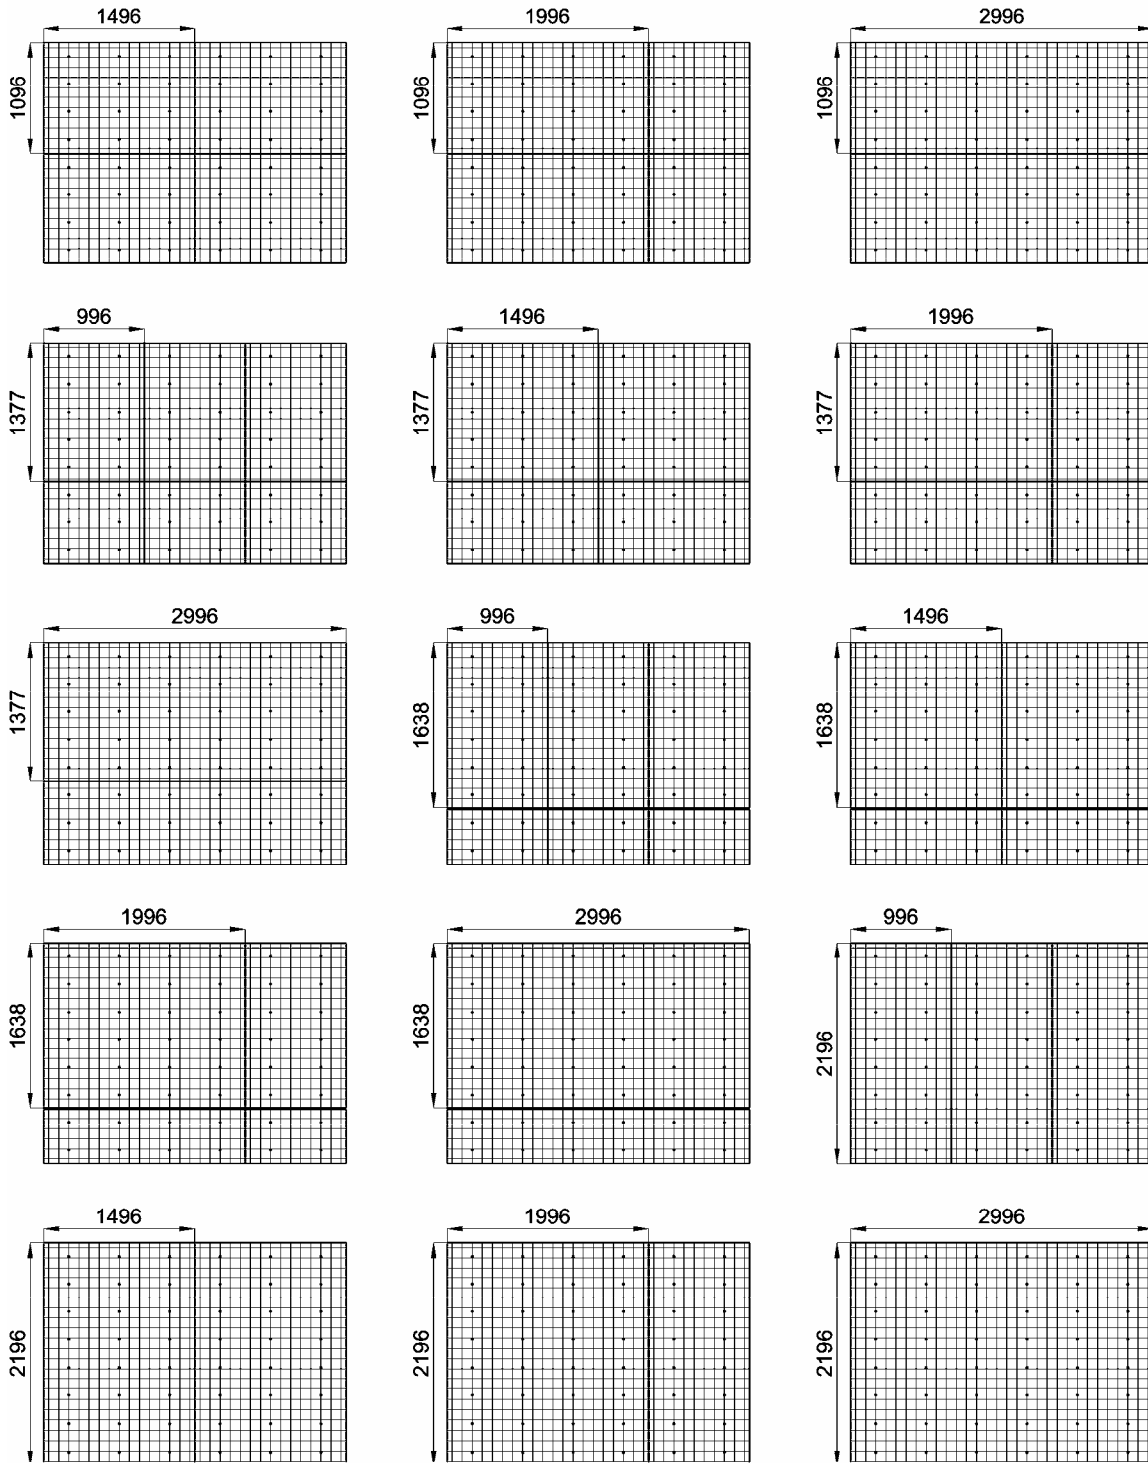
Corte del panel estándar. Mayores dimensiones.
